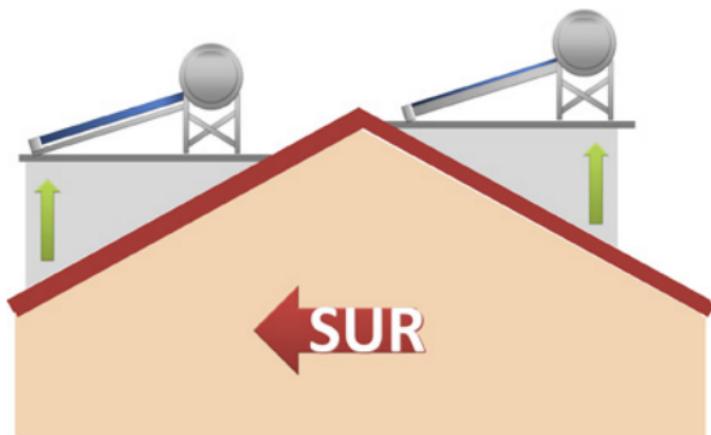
Instalación de CSA en techos con inclinación NORTE/SUR.
